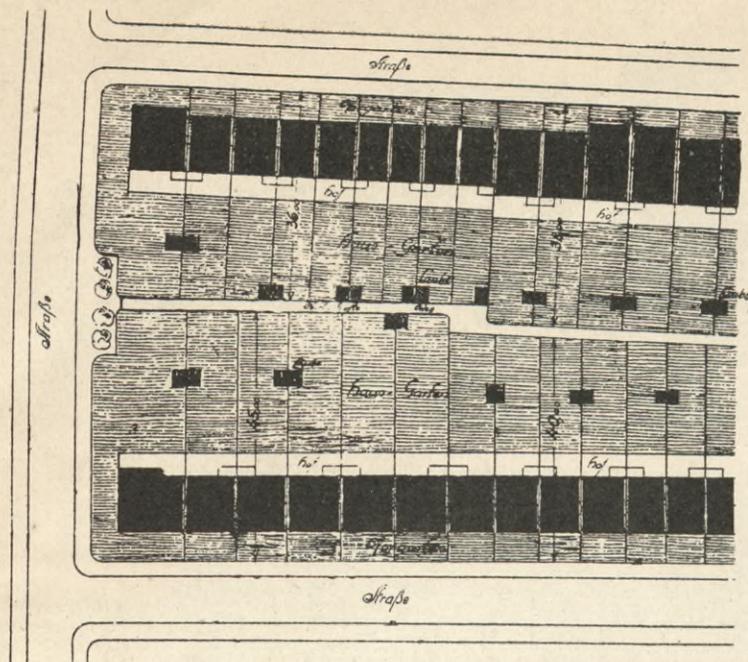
Bebauungsplan für eine Reihenhausanlage des Berliner Beamtenwohnvereins
